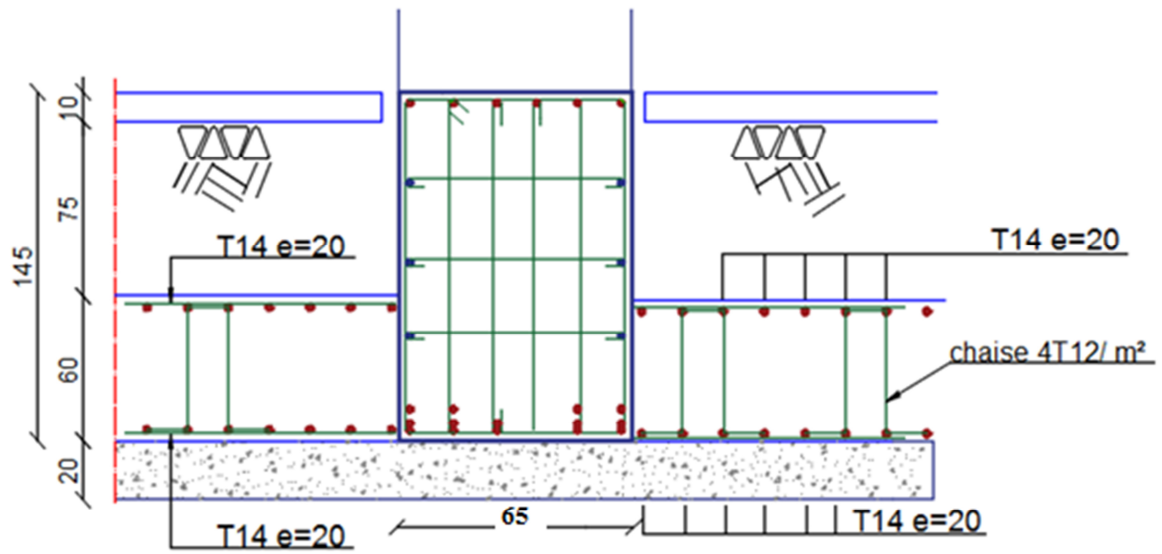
exemple Ferrailage de radier aux appuis sens x-x.
